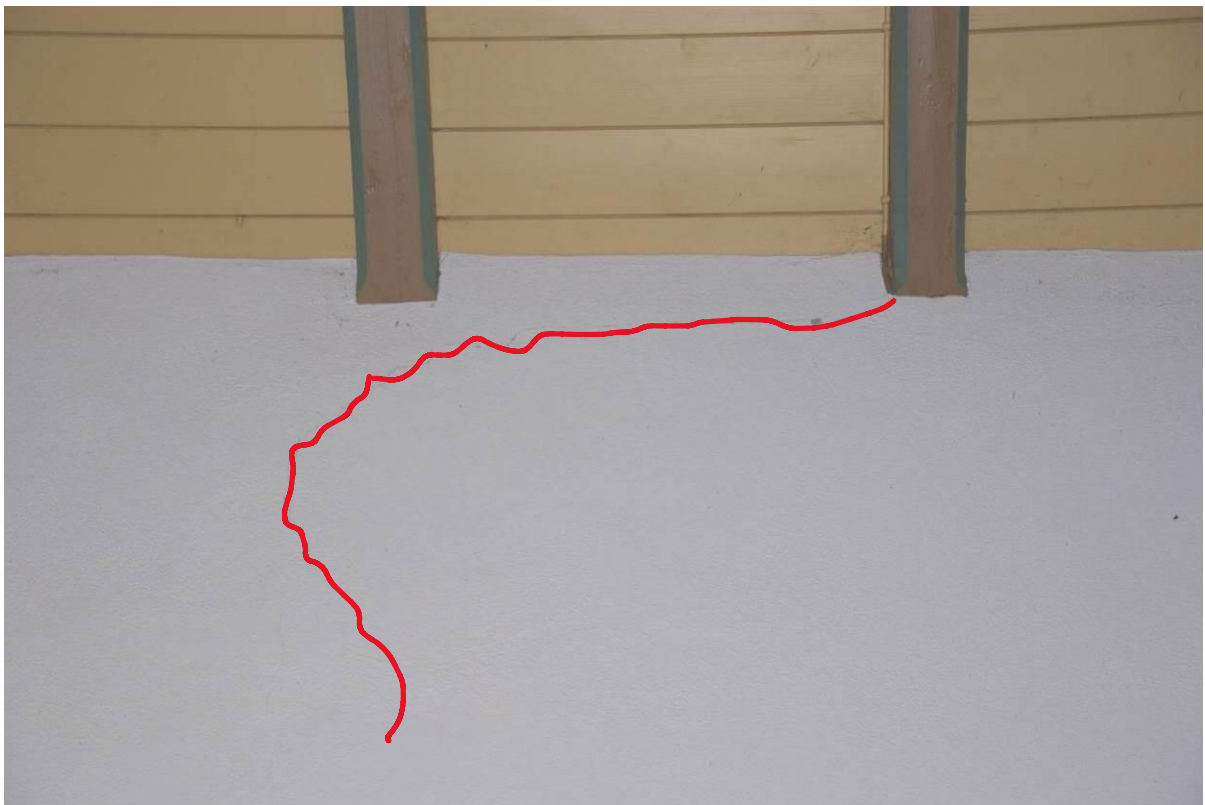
Nördliche Außenwand: Mauerwerksrisse durch Schubkräfte aus der Dachkonstruktion.
